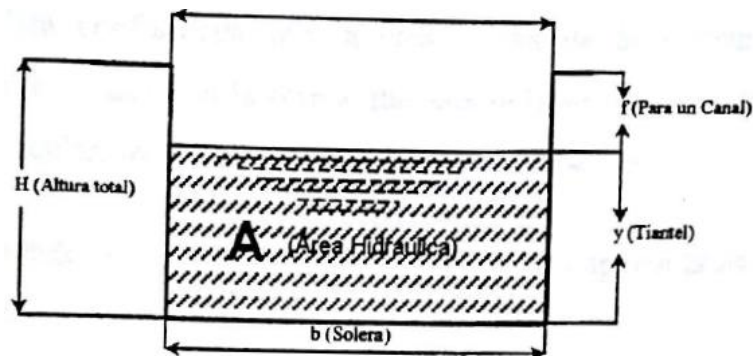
Sección rectangular de un canal (Fuente: Walter Morales Uchofen, "Infraestructura de Riego")
